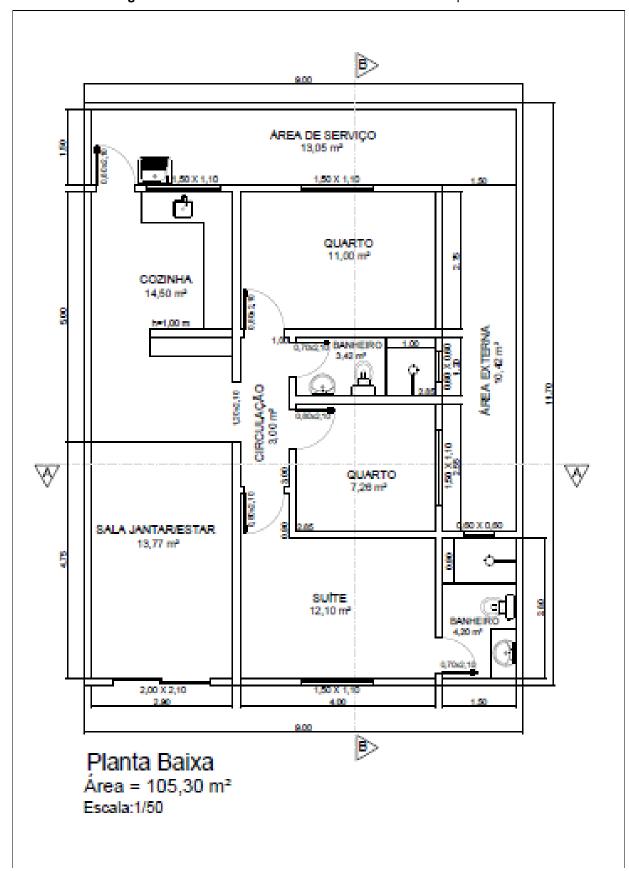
Planta Baixa da Residência Unifamiliar de um pavimento.
